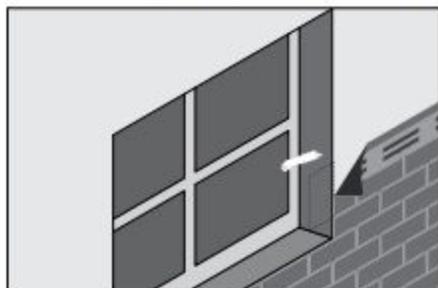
Монтаж фасадной плитки вокруг оконных проемов
